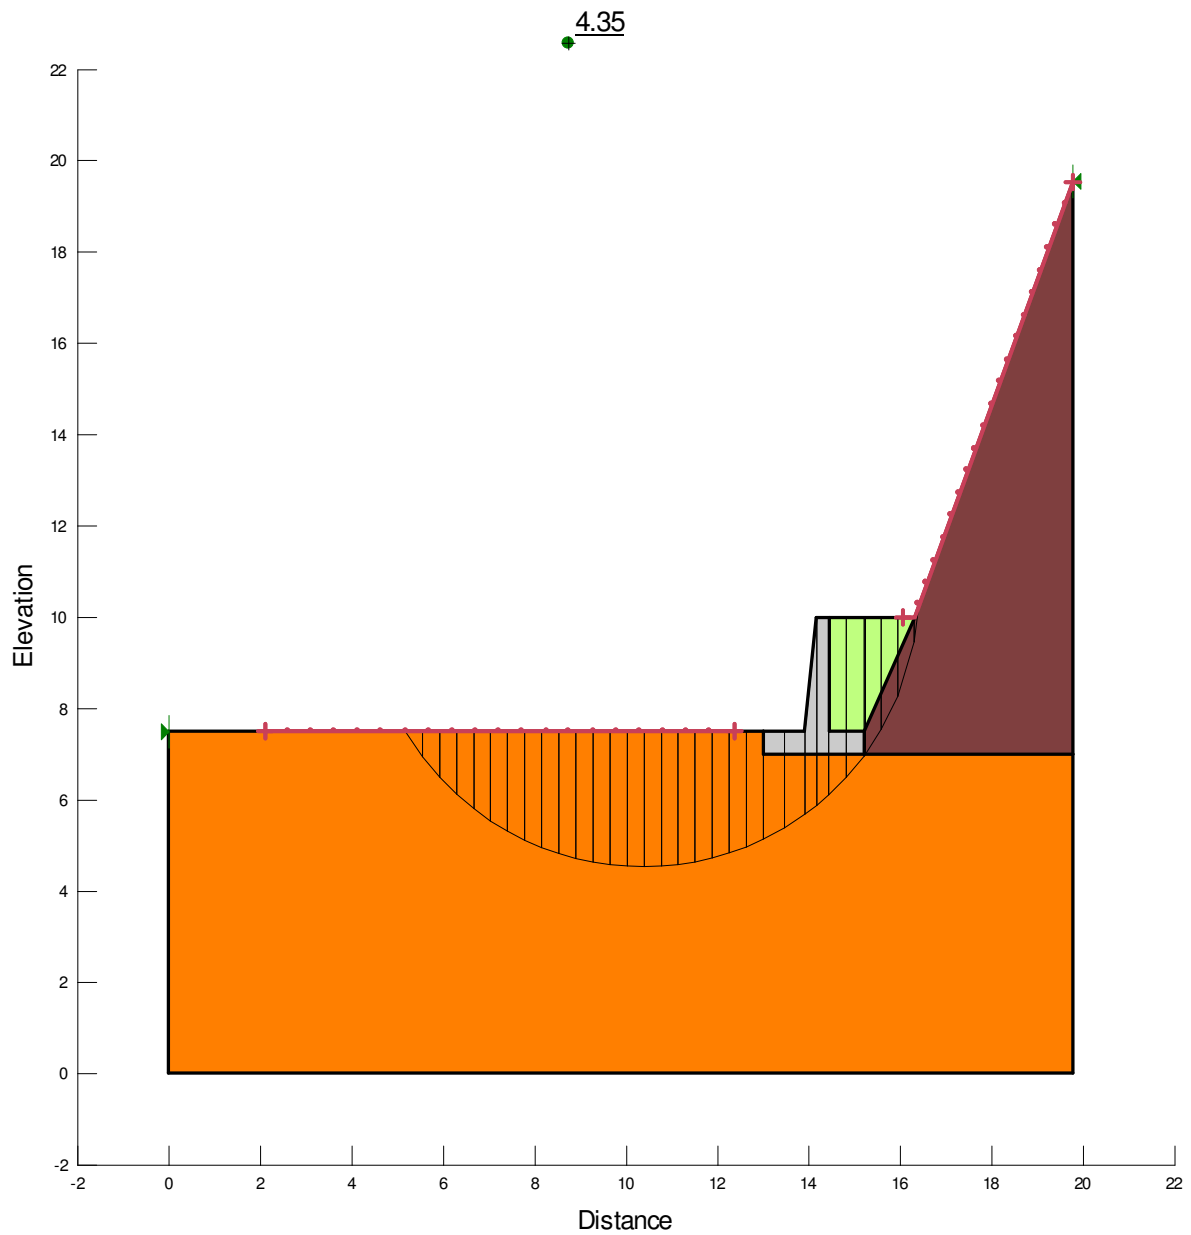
Muro tipo 1 e 2, risultati della verifica di stabilità in condizioni statiche
